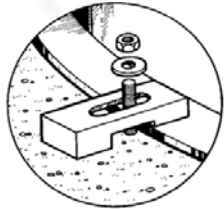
Крепление дна резервуара к фундаментной плите башмаками
